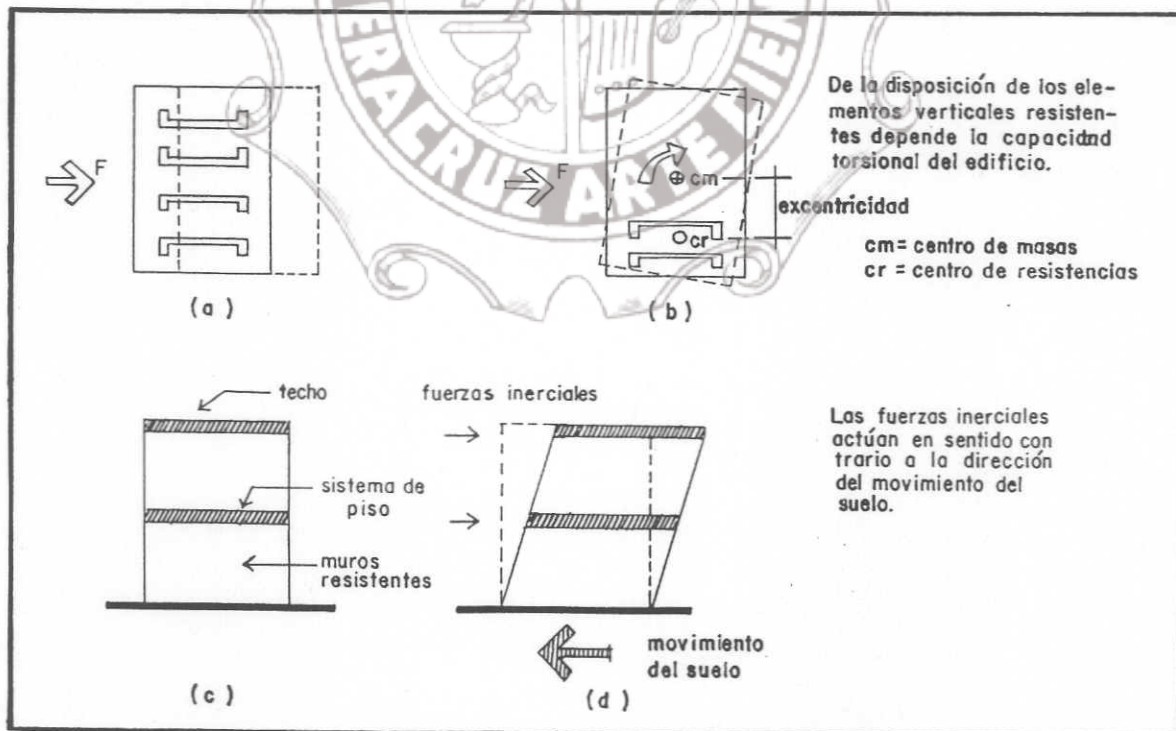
Planta de un edificio bajo fuerzas laterales (a) sólo con desplazamiento lateral y (b) con torsión. Elevación de una construcción de mampostería y sus fuerzas inerciales.
